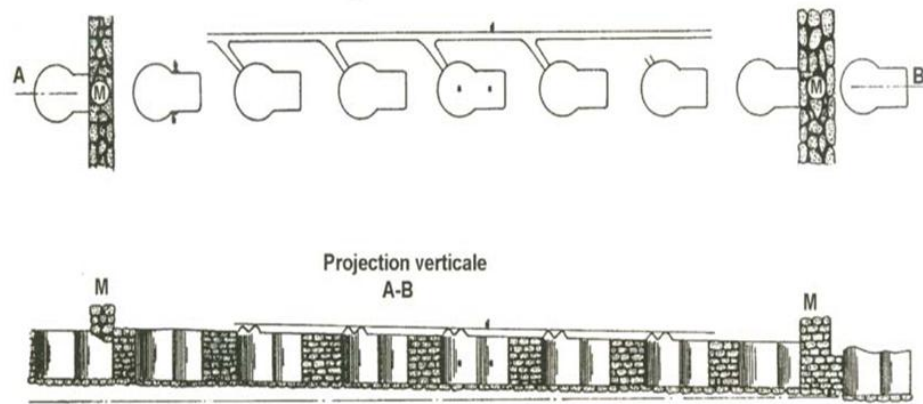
Vistas en planta y alzado del Coto de la Fortuna (Antolinos y Orejas, 2001)
